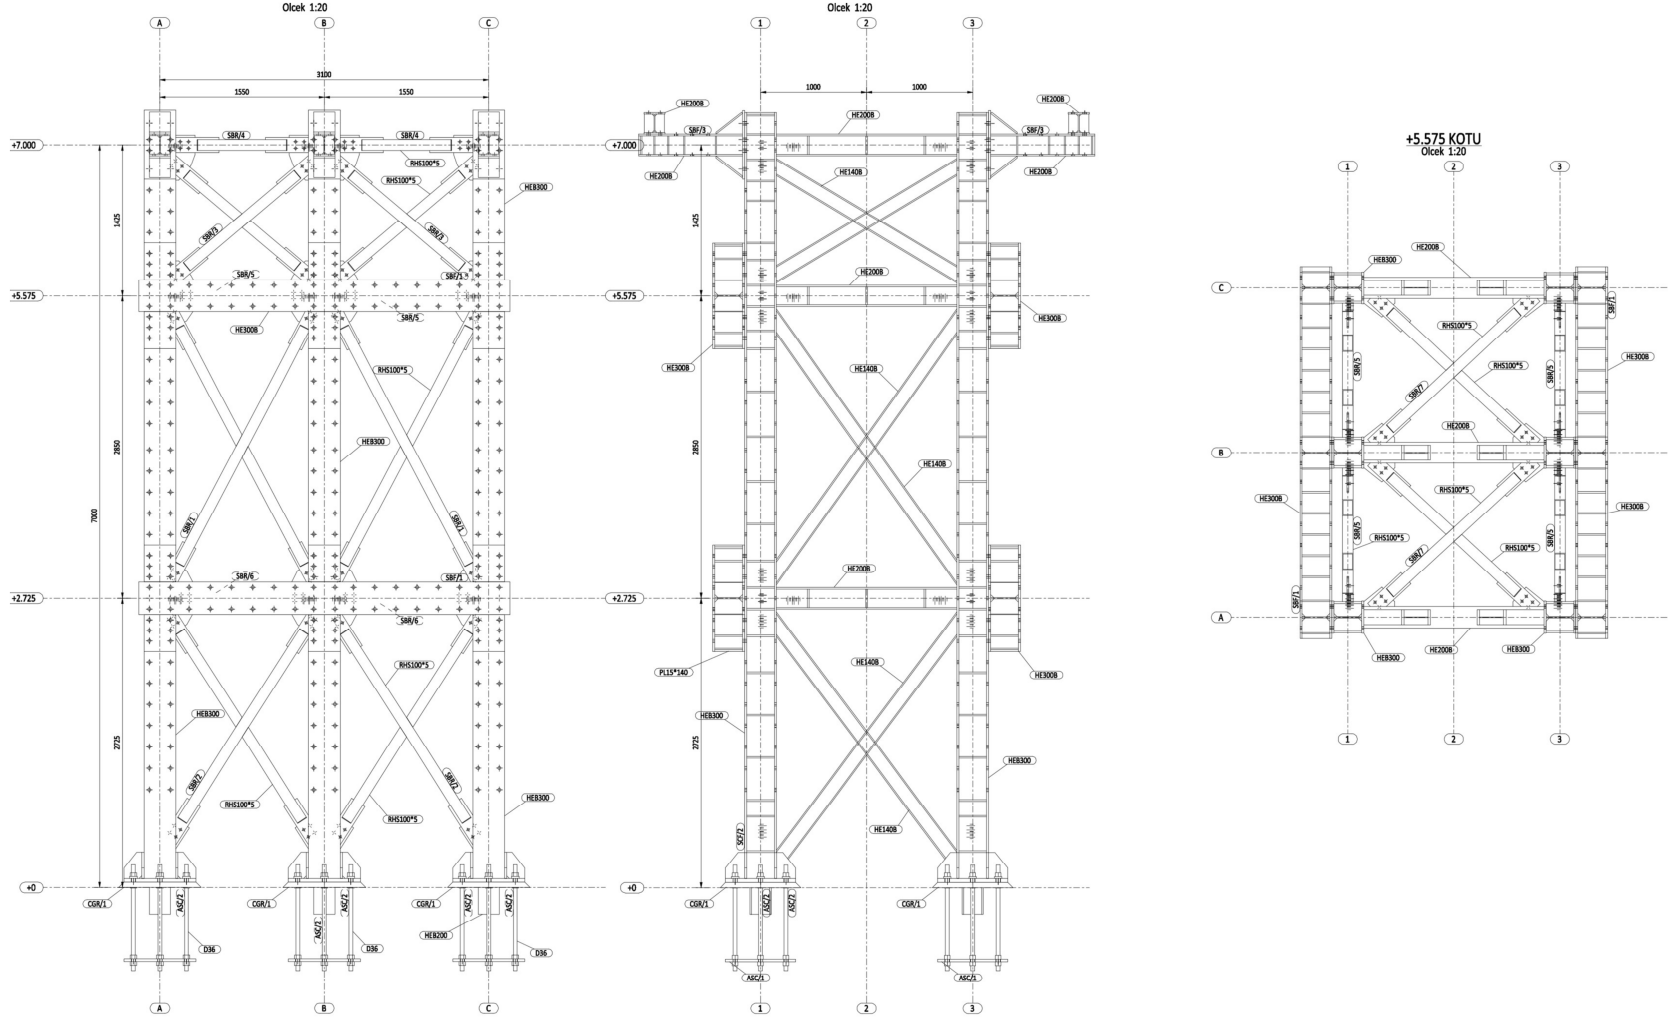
Test binaları kolon aplikasyon planı ve kolon detayları
